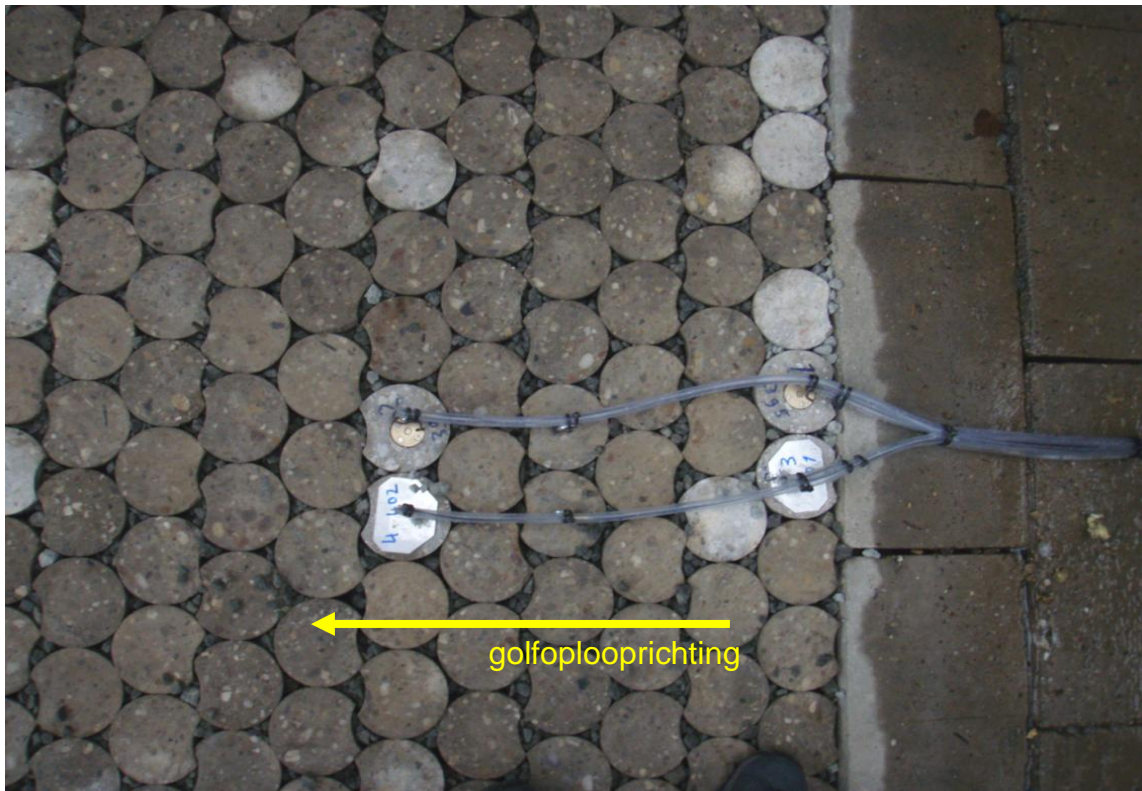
Modelopstelling (bovenaanzicht DRO's in testsectie zuilen)
